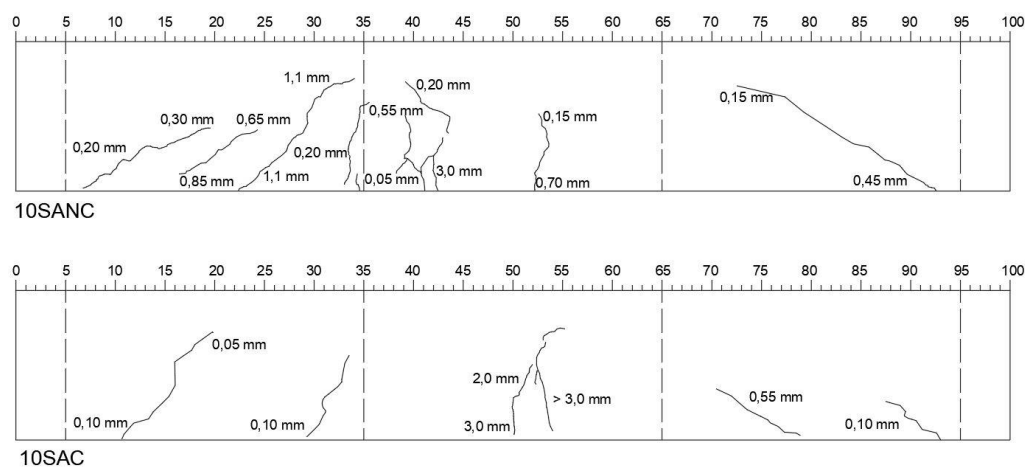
Mapeamento fissuração viga com adição de cinza de casca de arroz
